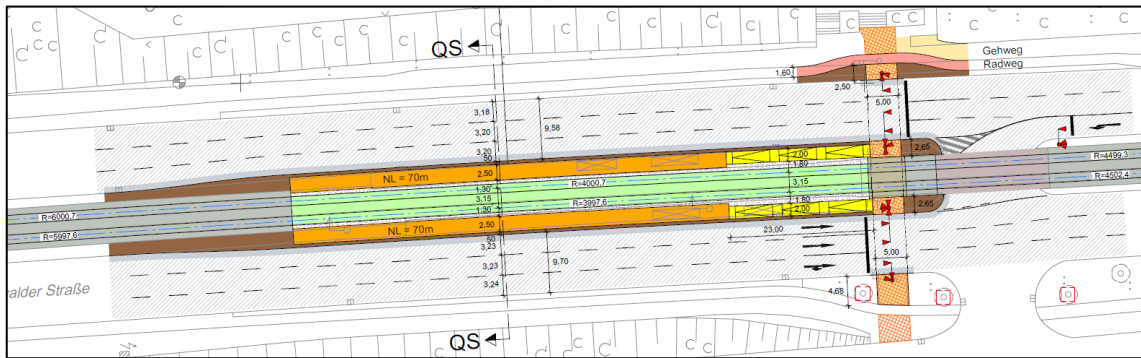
Ausschnitt Lageplan Variante 1 (MBU), V1_VA0LA1
